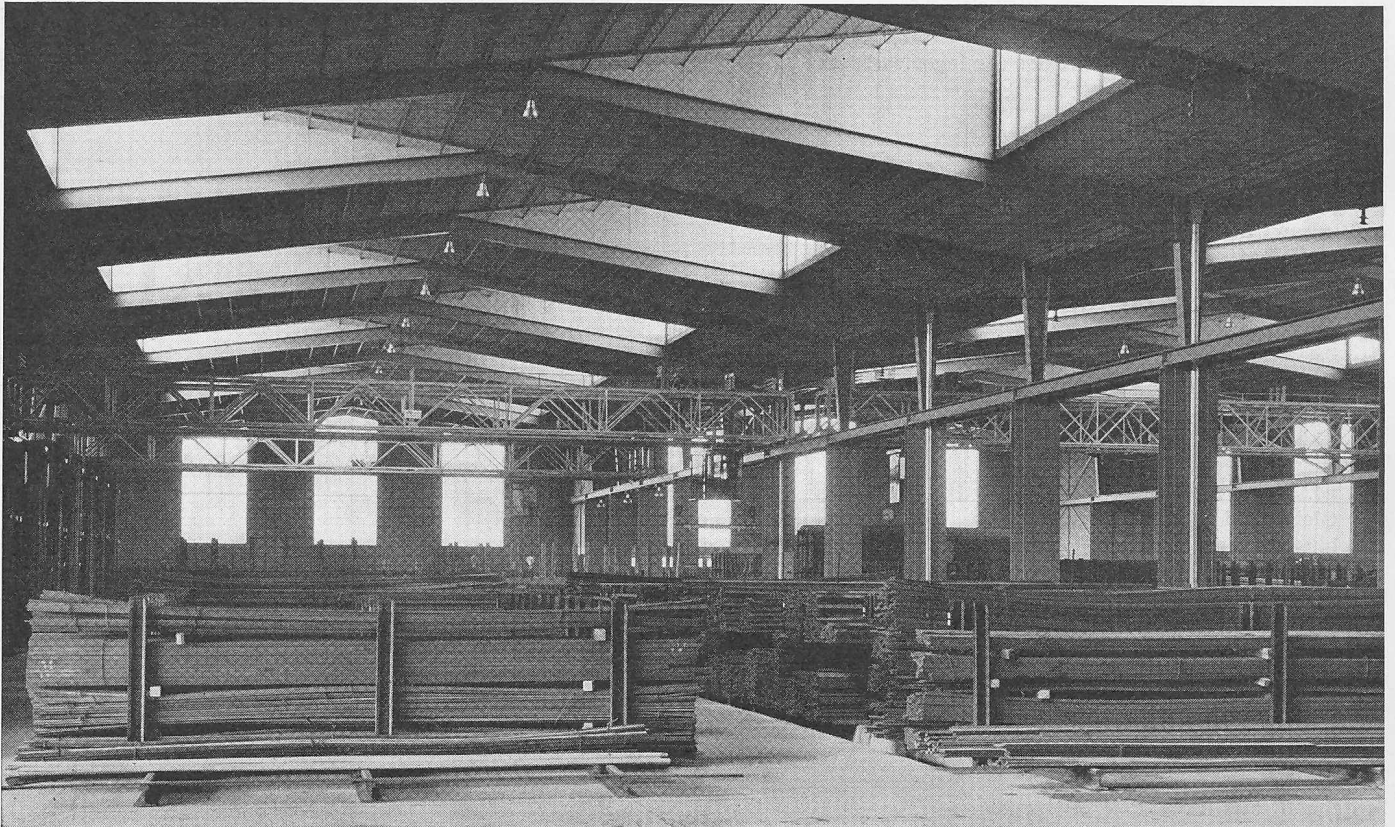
Hallen-Durchblick längs mit Oberlichtern. Im Hintergrund Laufkrane von 30 m Spannweite
